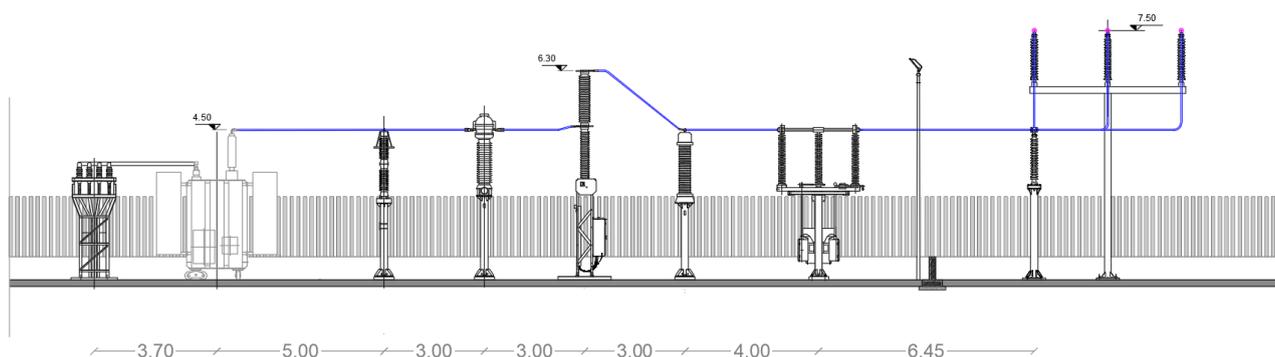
Sezione Longitudinale elettromeccanica stallo di trasformazione 150/30 kV
